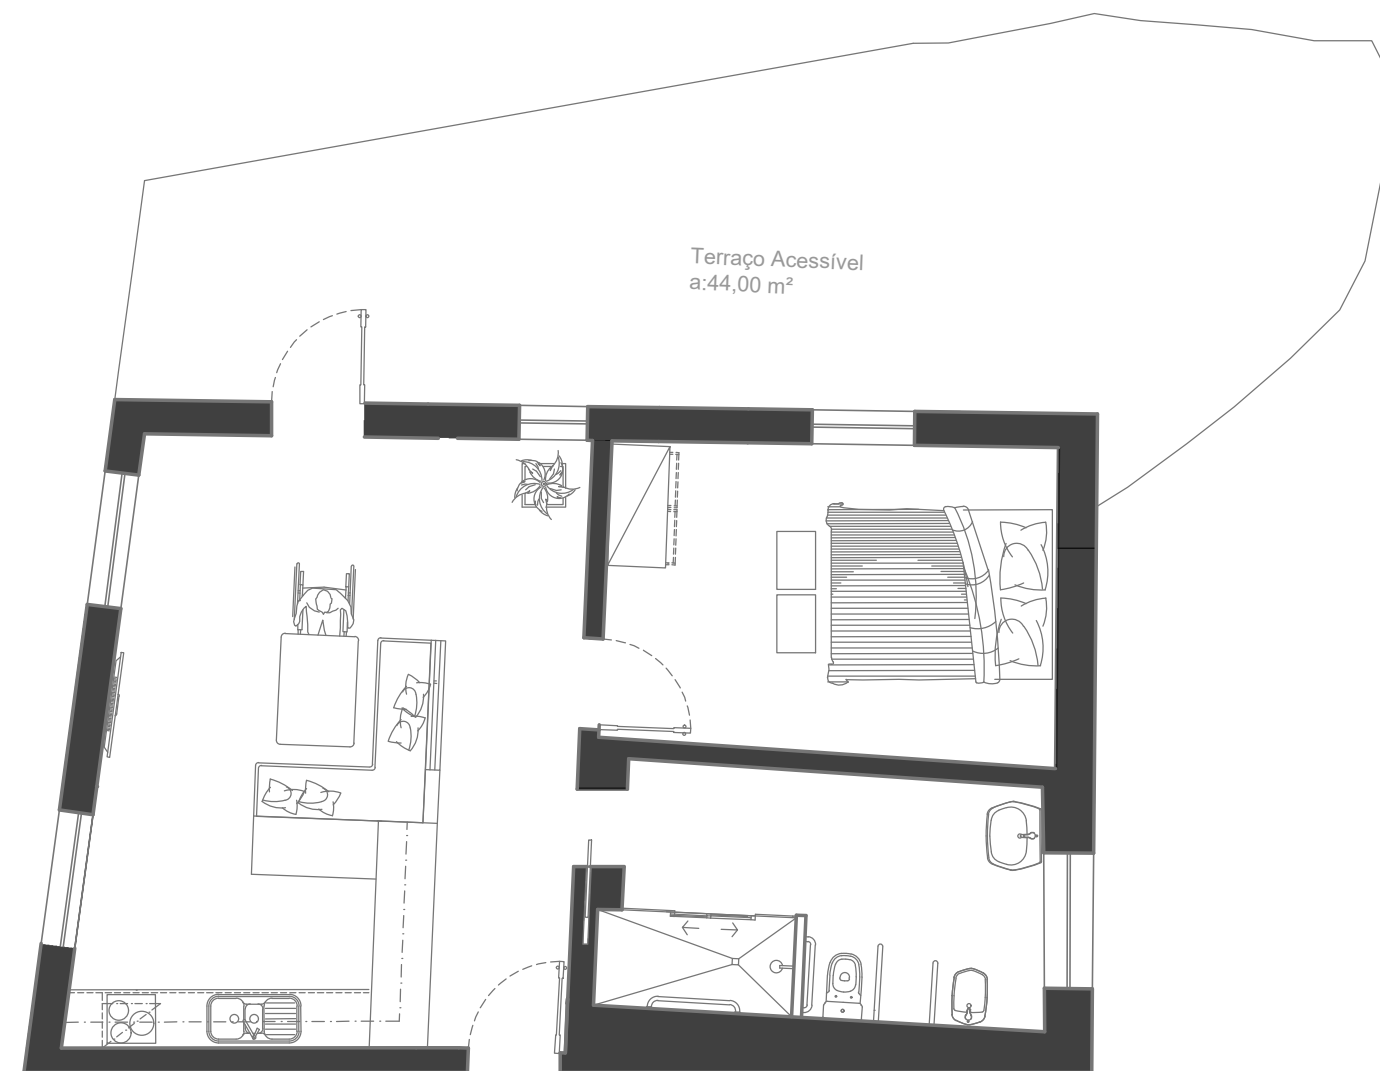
Casa 1: Planta do Proposto – R/Chão. Esboço 2
